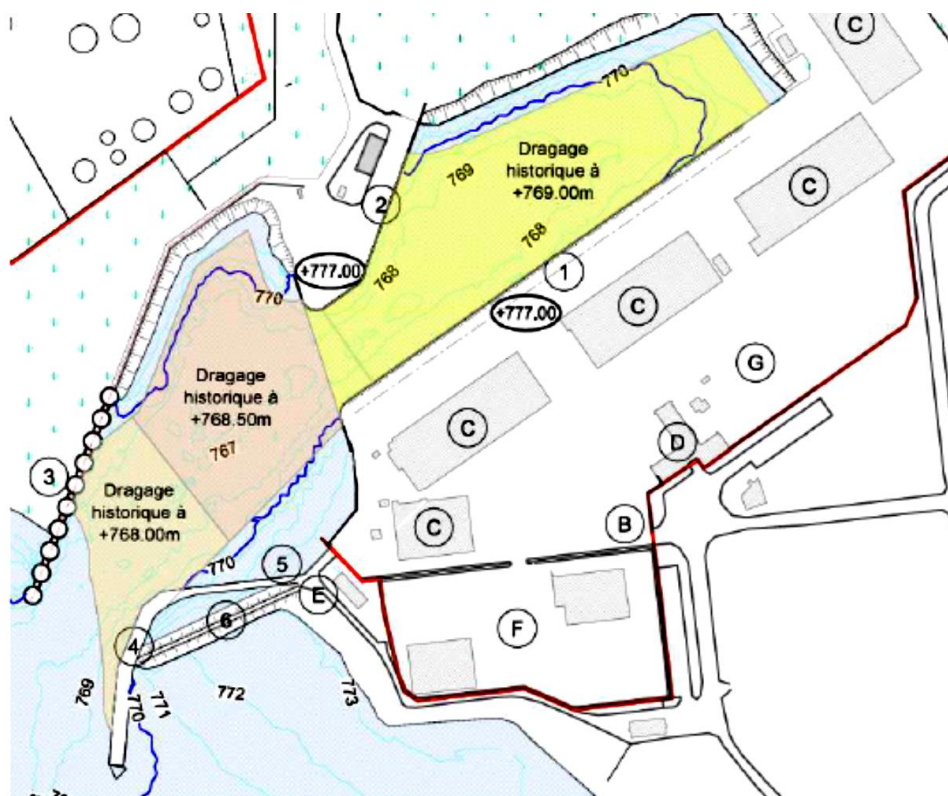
Niveaux de dragages historiques (source: ARTELIA, 2016)
